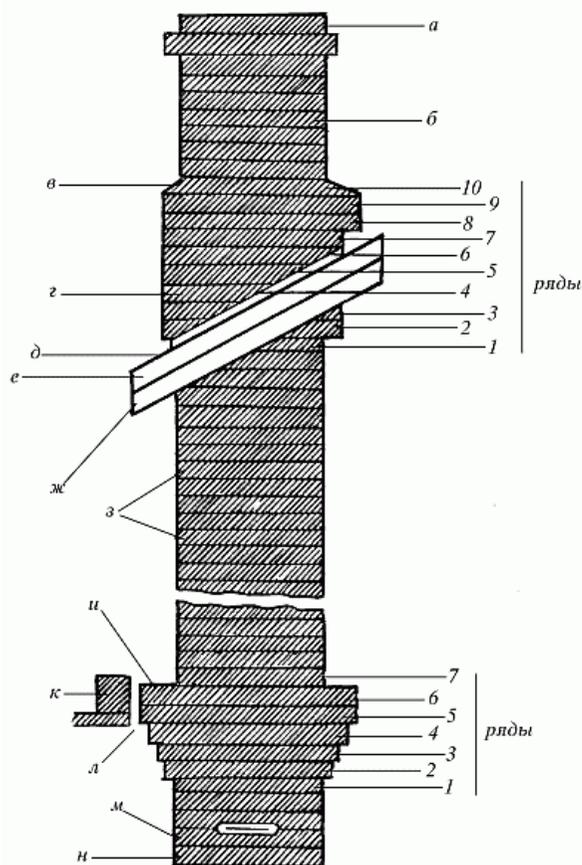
Устройство дымовой трубы: а — оголовок трубы; б — шейка трубы; в — цементный раствор; г — выдра; д — кровля; е — обрешетка; ж — стропила; з — стоек трубы; и — распушка; к — балка с перекрытием; л — изоляция; м — дымовая задвижка; н — шейка печи
